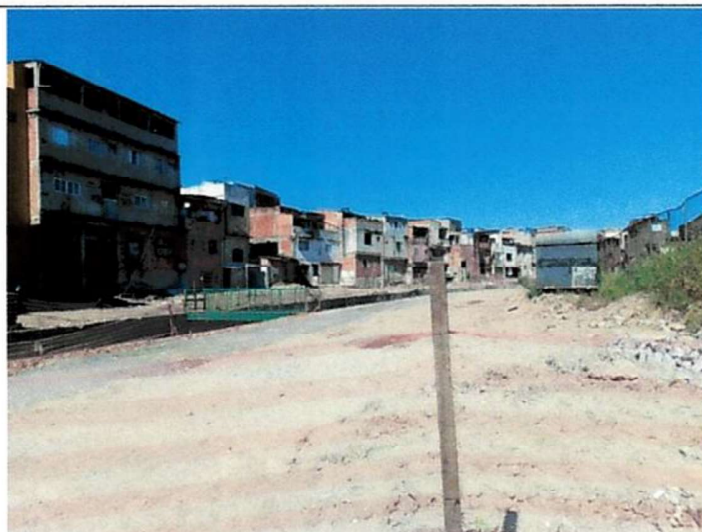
Vista do Campo de Futebol para a Av. Luiz Pequini, com córrego canalizado e vista do bairro em frente
